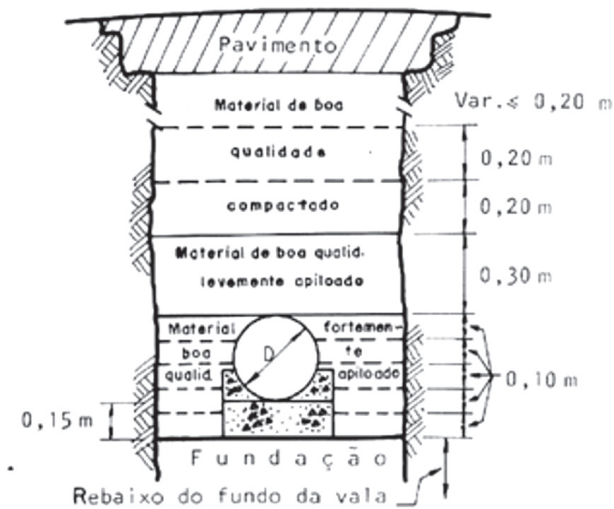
Apoio sobre laje e berço de concreto
